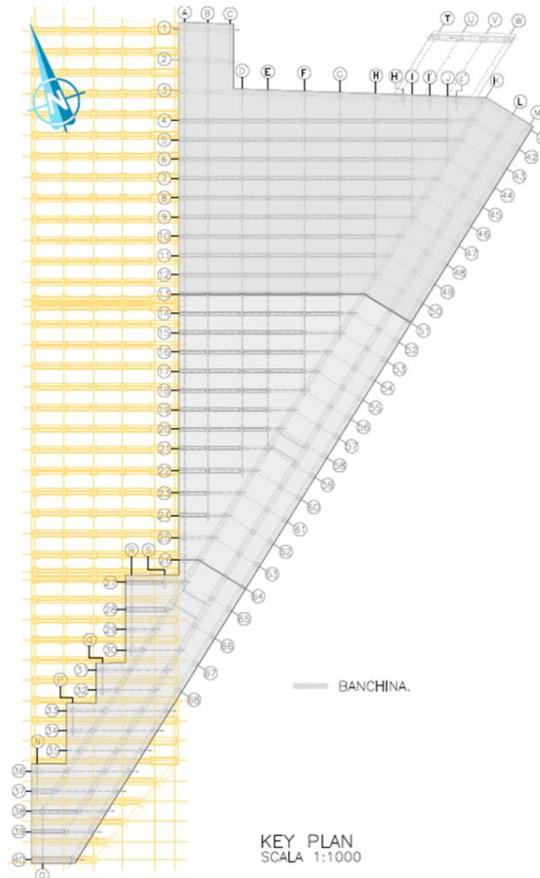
planimetria della banchina di allestimento (in grigio) e della banchina esistente (in giallo)
